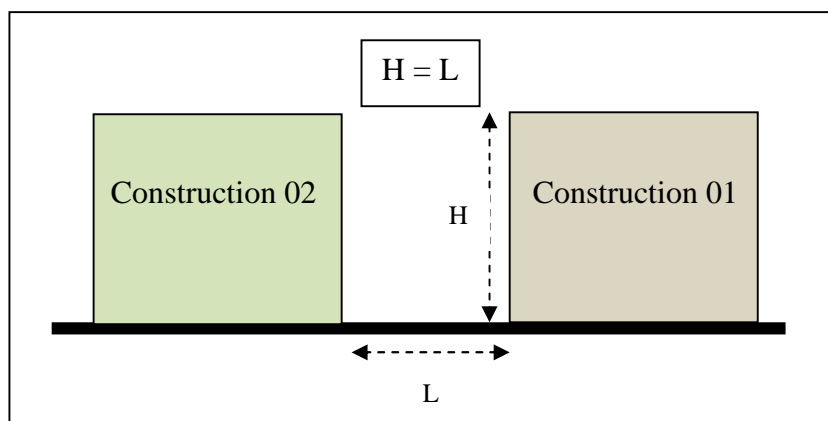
Coupe schématique arrêtant la hauteur d'une construction en bordure d'une voie
